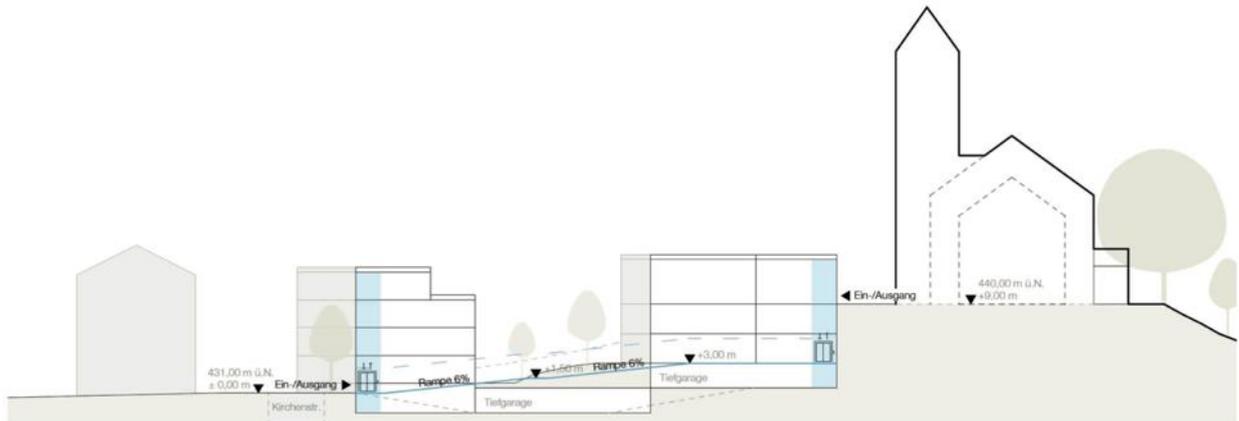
Schnittschema barrierefreie Erschliessung Gebäude
